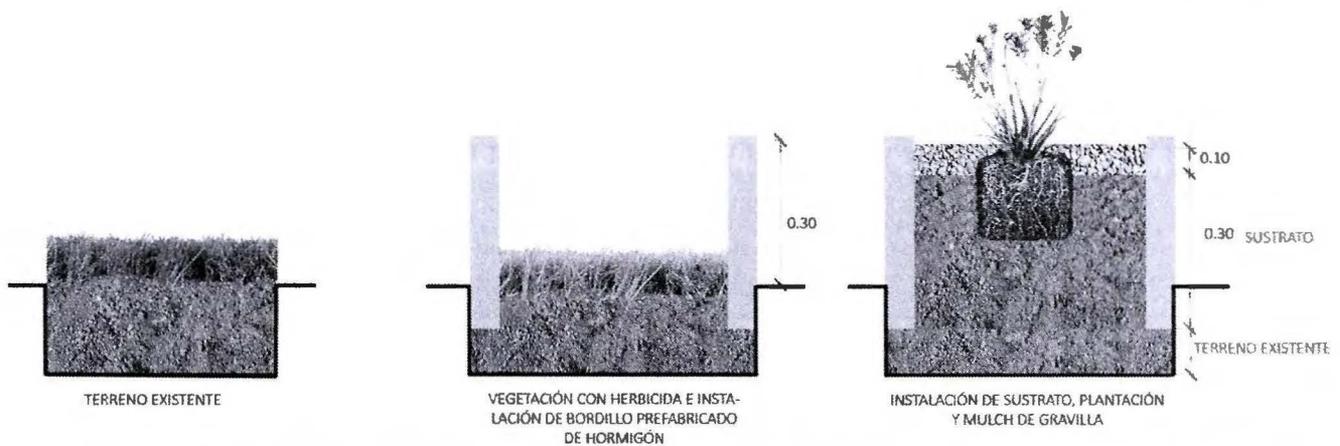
Modo de Plantación modelo escape superficial con levante de terreno de 10 y 30 cm.
